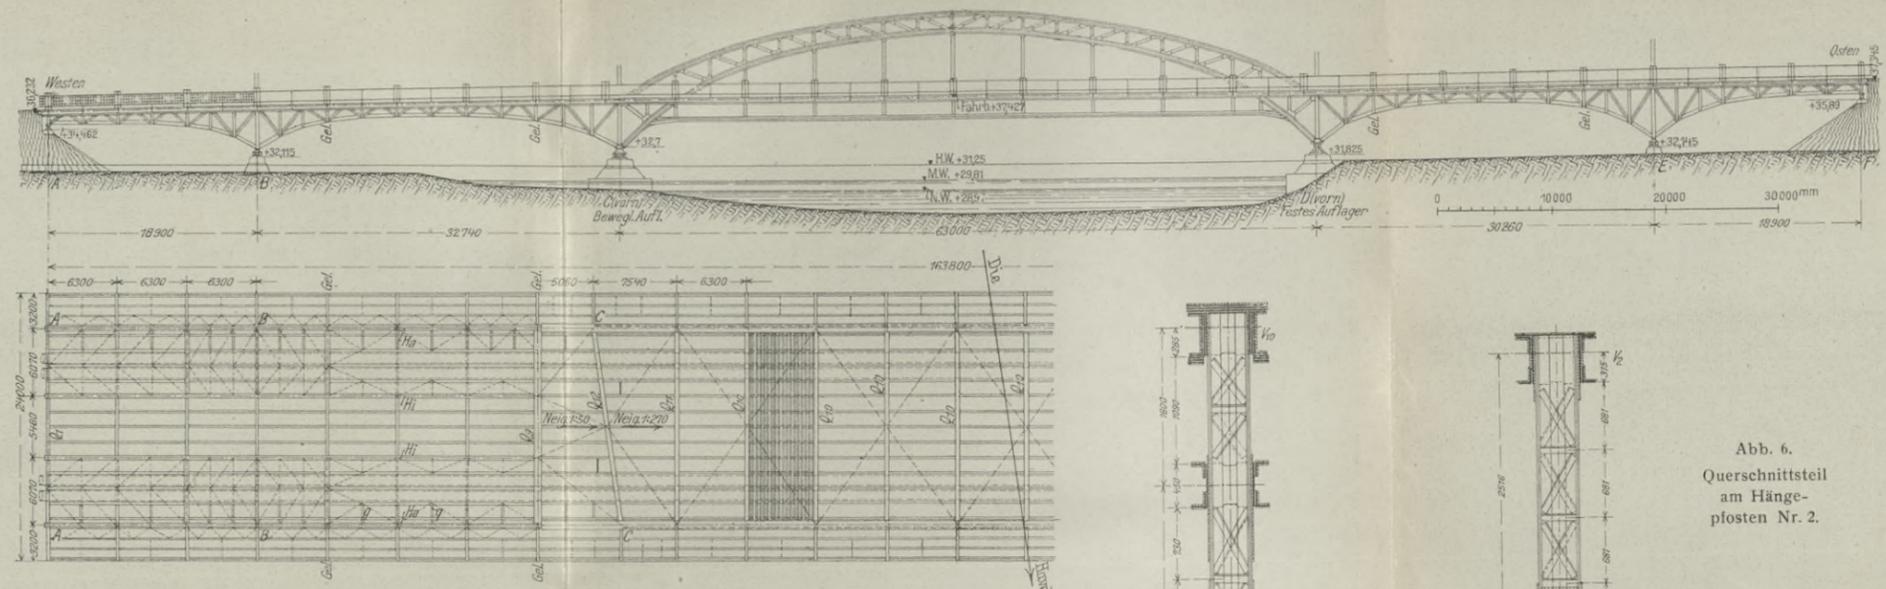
und 3. Gesamtansicht der Brücke und halber Grundriß der Fahrbahnkonstruktion.
